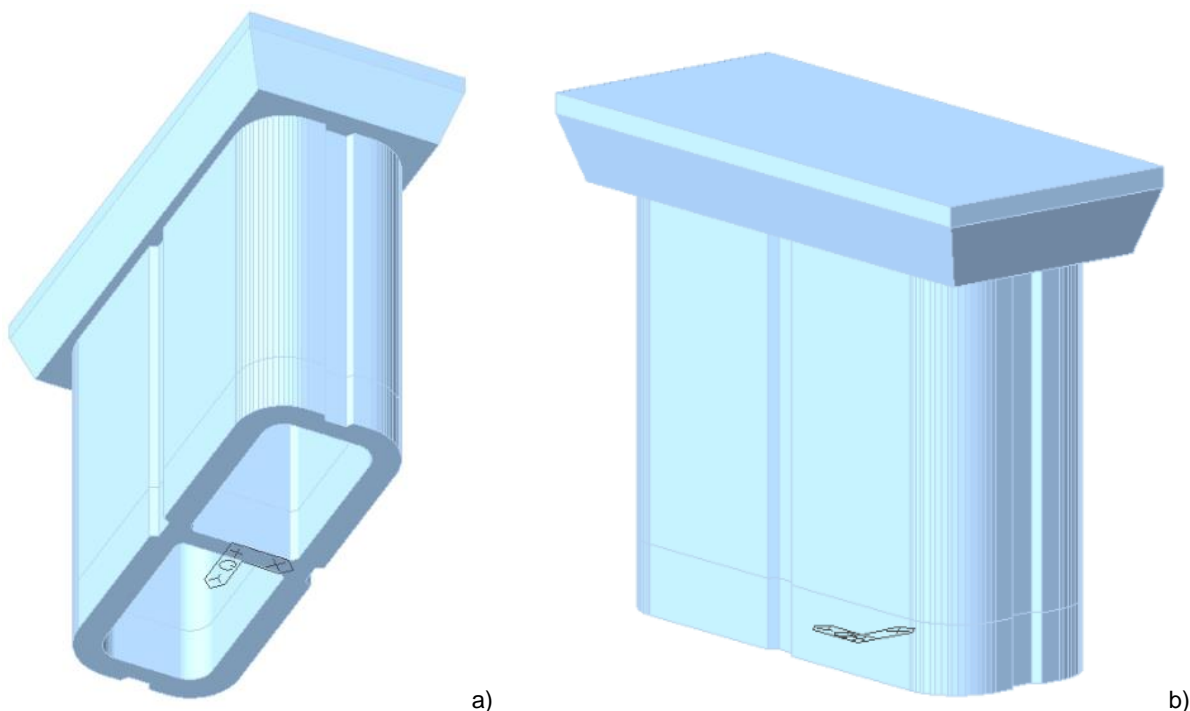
Modellazione tridimensionale agli Elementi Finiti – a) Vista 3D dal basso b) Vista 3D dall'alto
